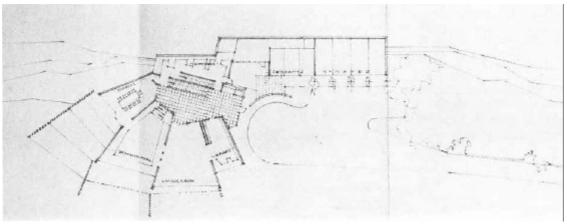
Boceto inicial y plano planta baja de la casa Vila Erica, cerca de Turín Italia. Proyecto 1967.⁵⁷
